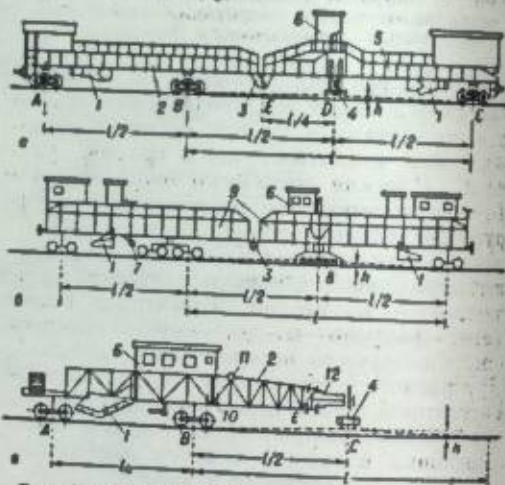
Схемы балластеров: а — ЭЛБ-1 и Б-3; б — ЭЛБ-3; в — Б-3 и консольного; 1 — дозаторы; 2 — консольная ферма; 3 — межферменный шарнир; 4 — подъемное устройство; 5 — балочная подвесная ферма; 6 — будка управления; 7 — рельсовые щетки; 8 — подъемное устройство с электромагнитами; 9 — фермы; 10 и 11 — шарниры поворота консоли; 12 — поворотная головка.
